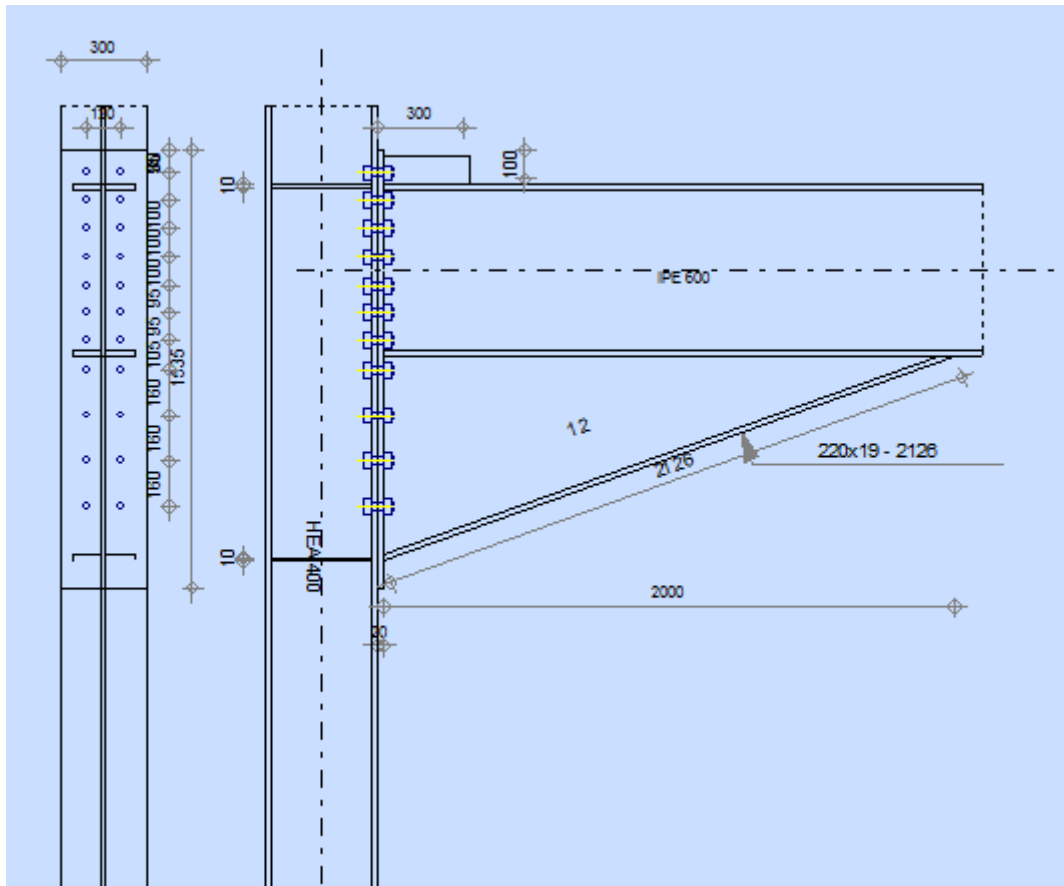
assemblage poteau HEA400 –poutre IPE600
